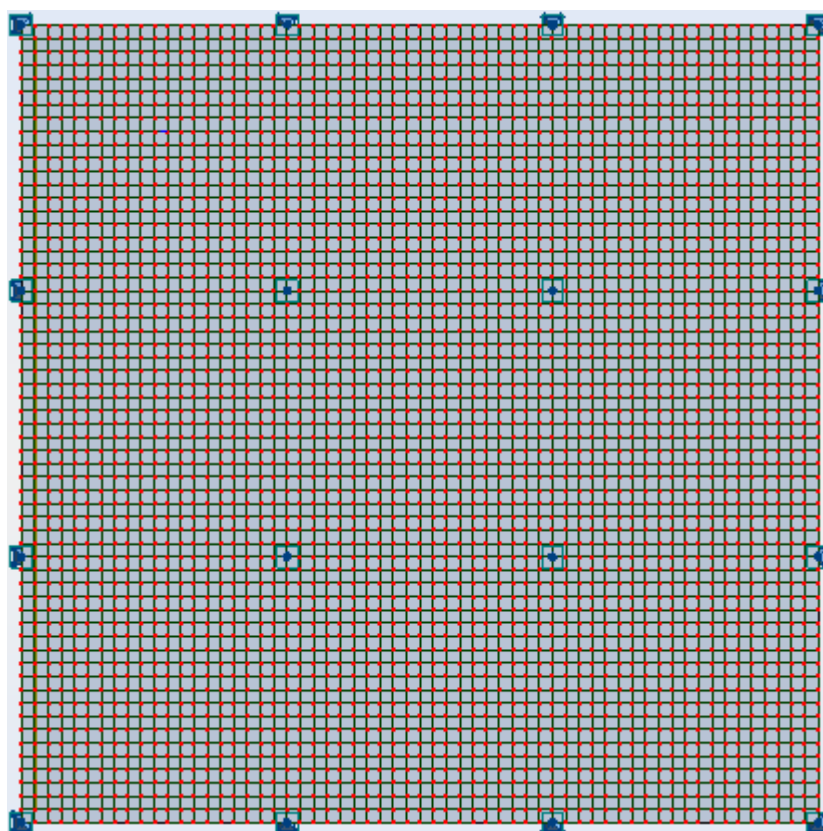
Laje fungiforme 15x15 m2 dividido em elementos finitos 0.25x0.25 m2
